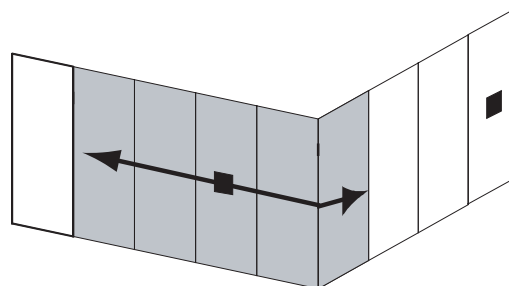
Connexions mur soudé/mur d'angle de bout en bout
